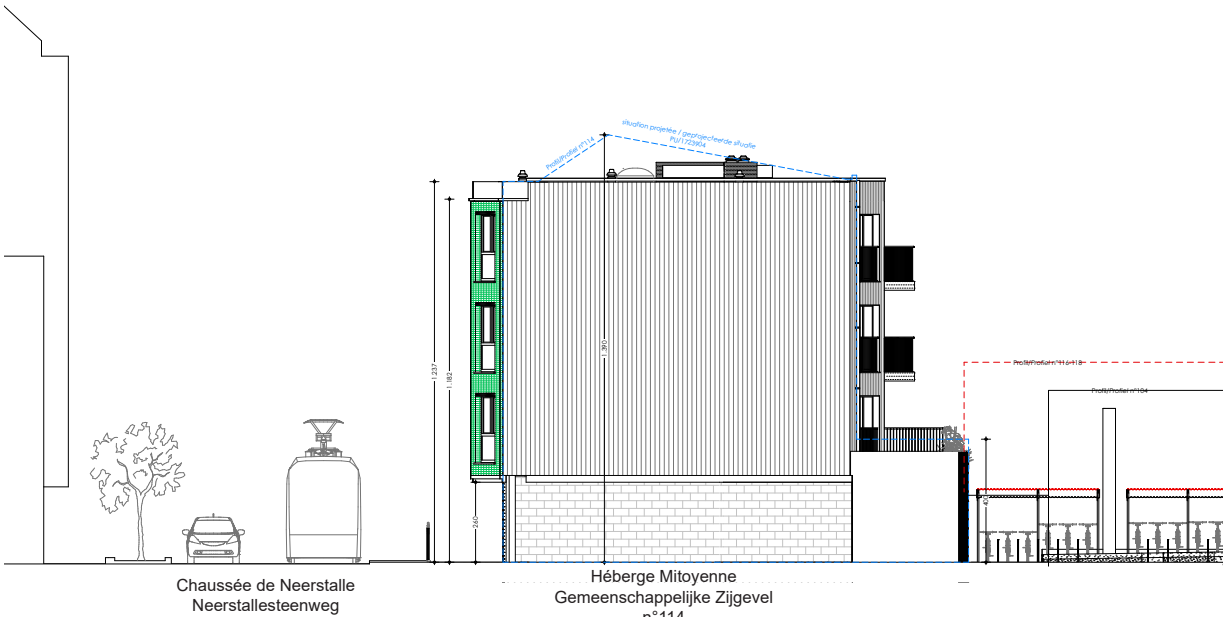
mur mitoyen en attente de construction, hauteur de facade dépassant le gabari apparent en situation de fait du n°114
